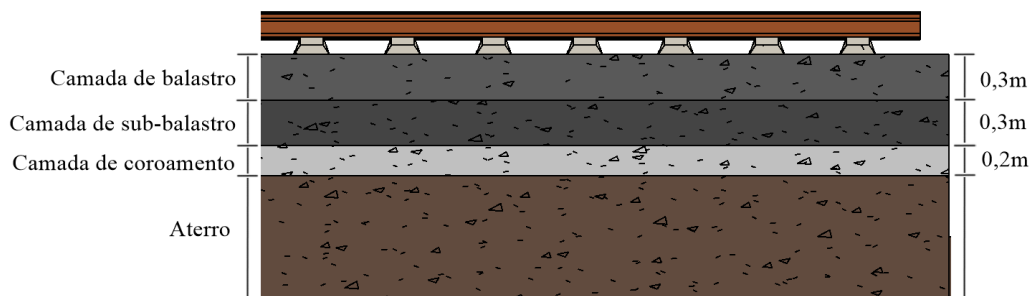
Representação 2D das camadas do pavimento em corte longitudinal.
